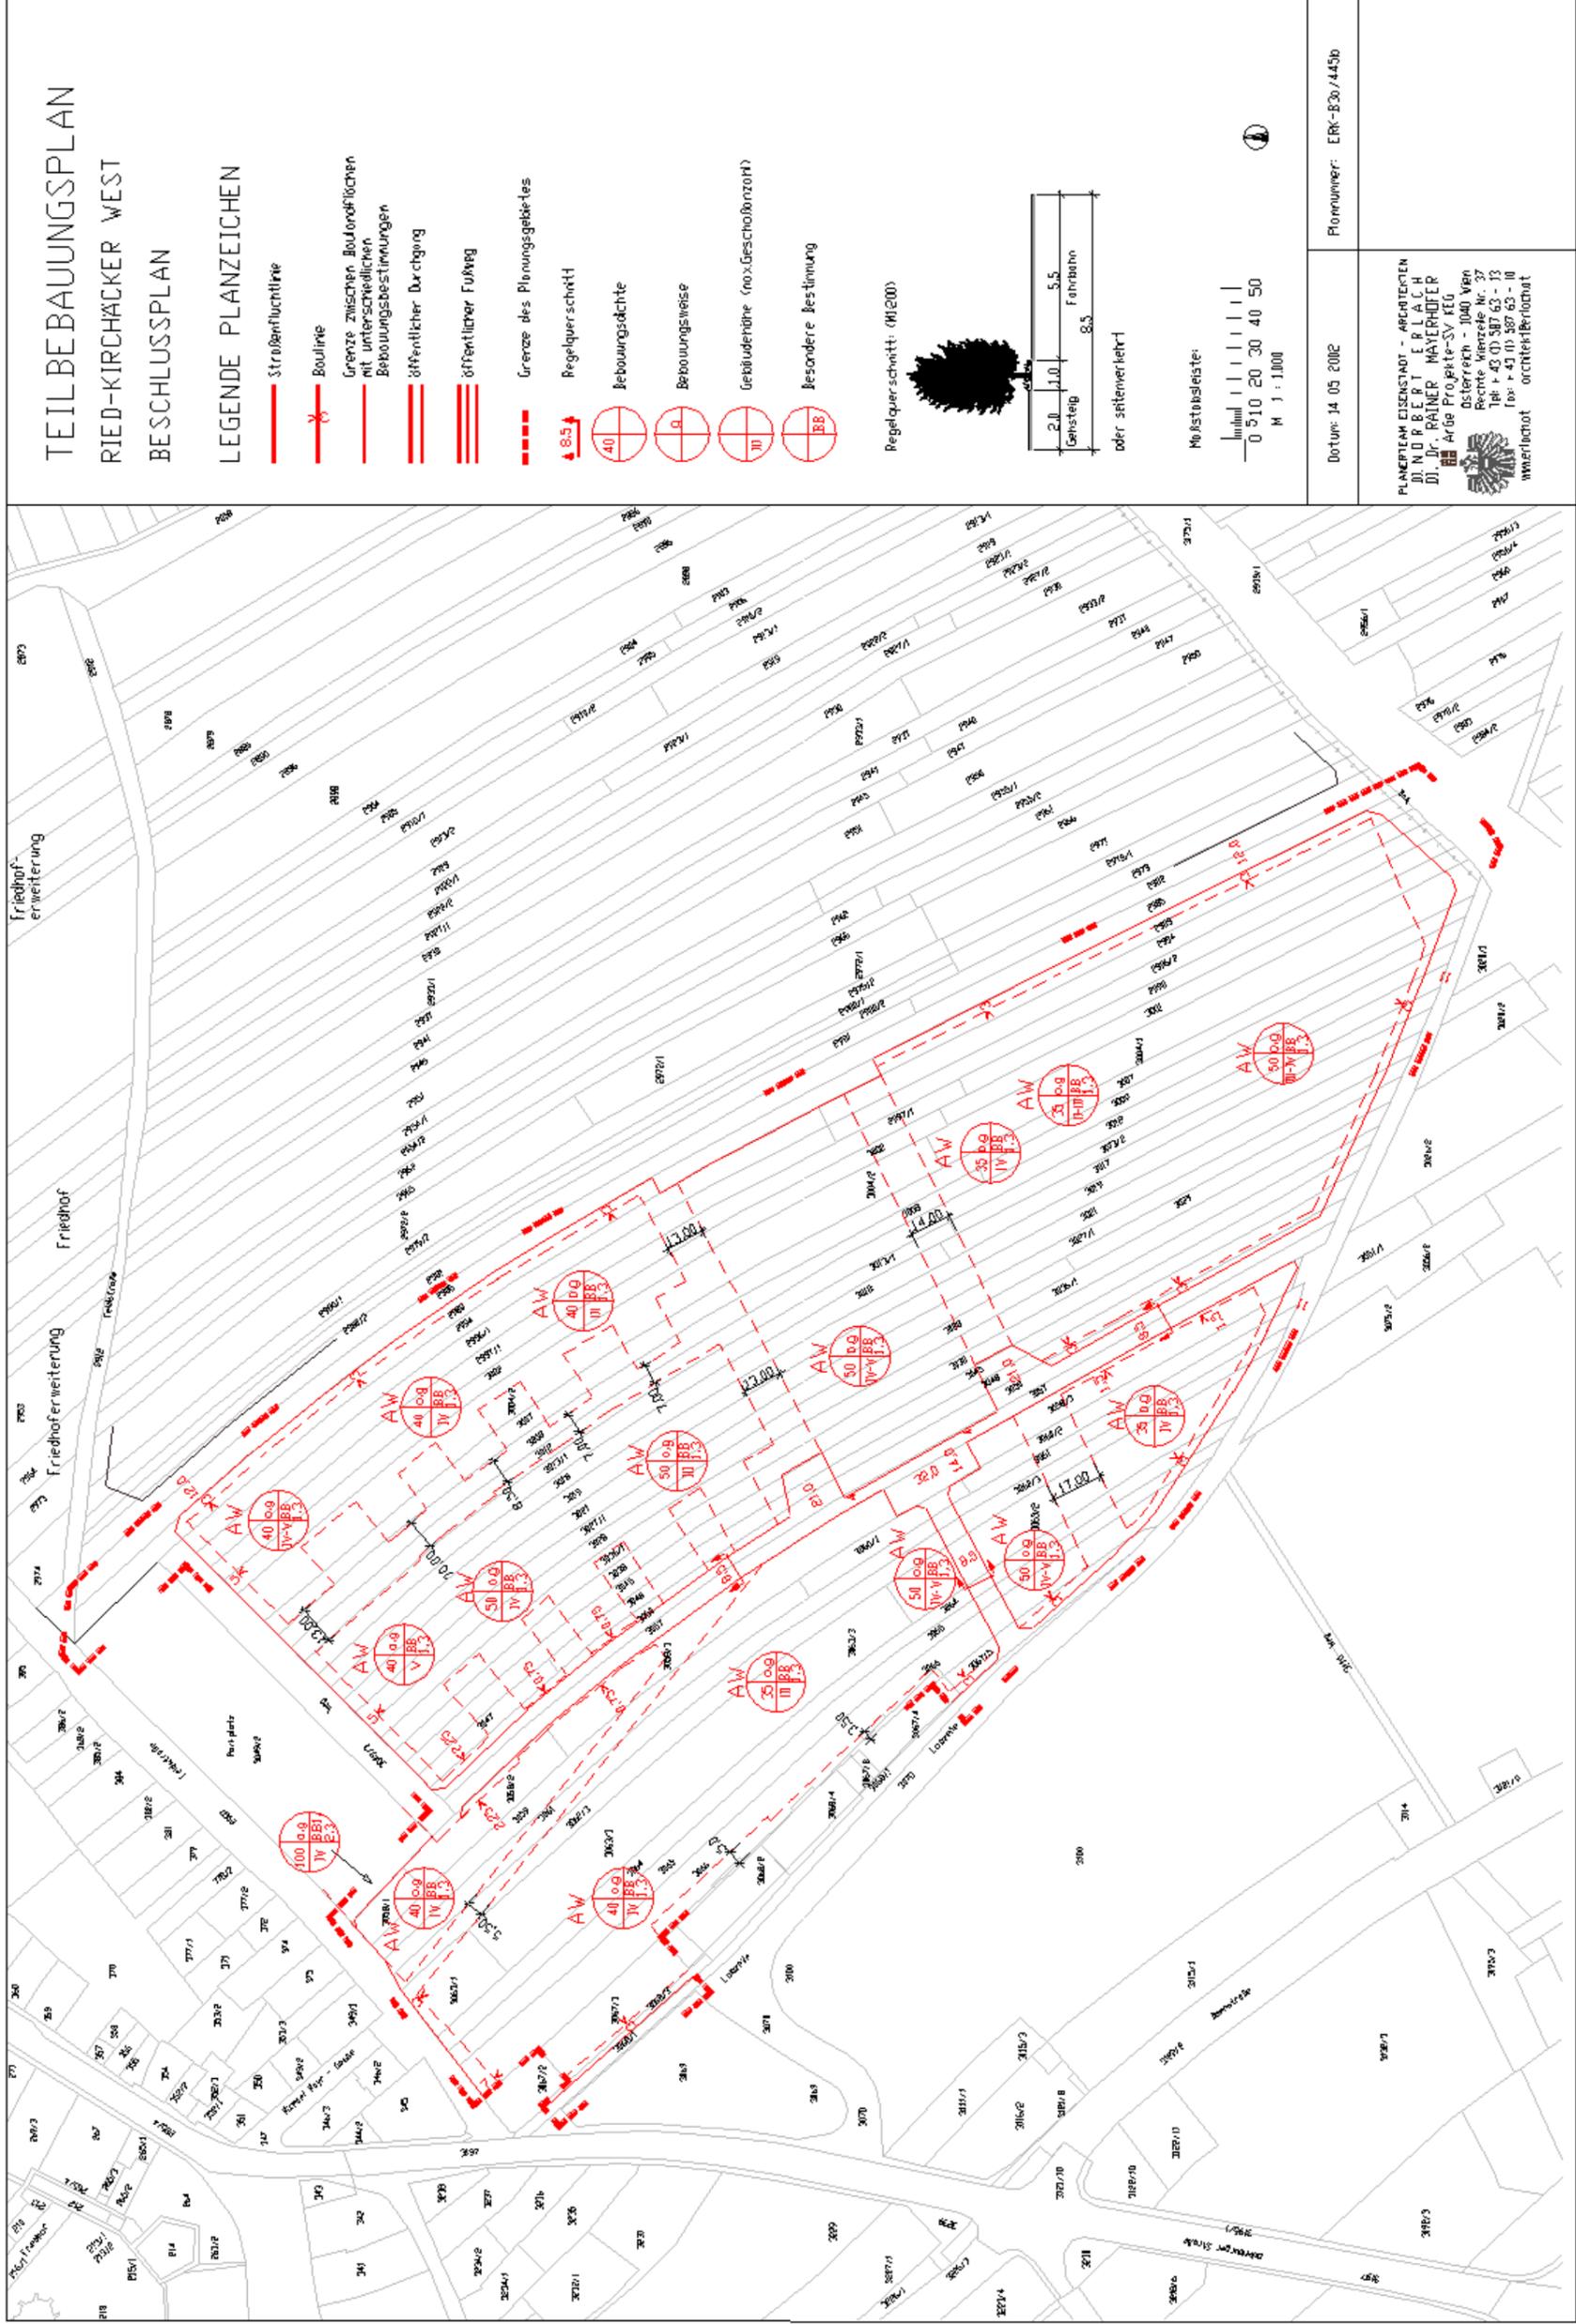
Teilbebauungsplan vom 14.5.2002 Plan Nr. ERK-B3a/445b, ohne Maßstab (Erlach et al. 2002)
